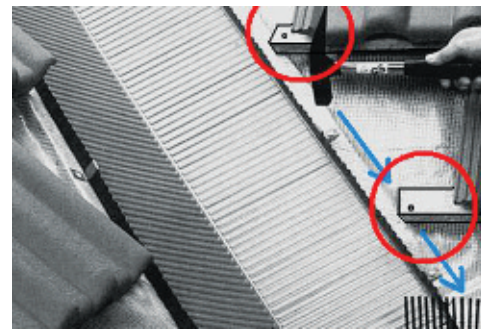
Грубая ошибка: обрешётка закреплена гвоздями вдоль водоотводящего желобка по краям настила ендовы. Попадание влаги под гидроизоляцию гарантировано
